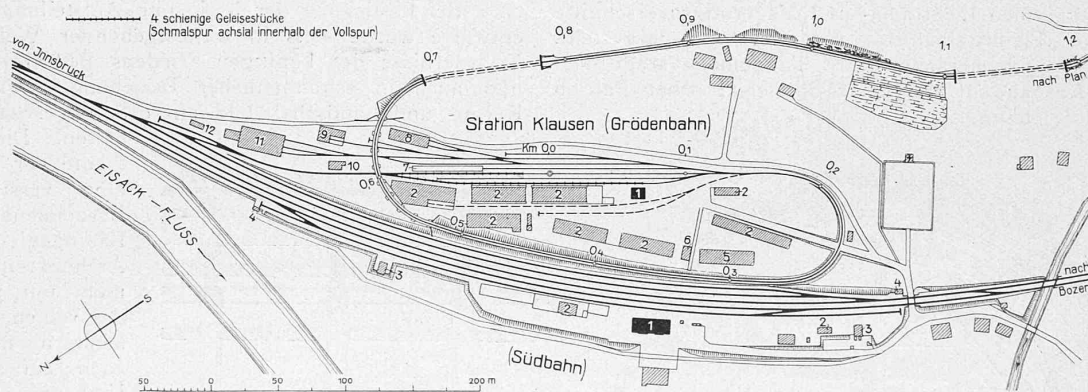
Anschluss-Bahnhof Klausen der Grödenbahn. — Lageplan 1 : 5000.
